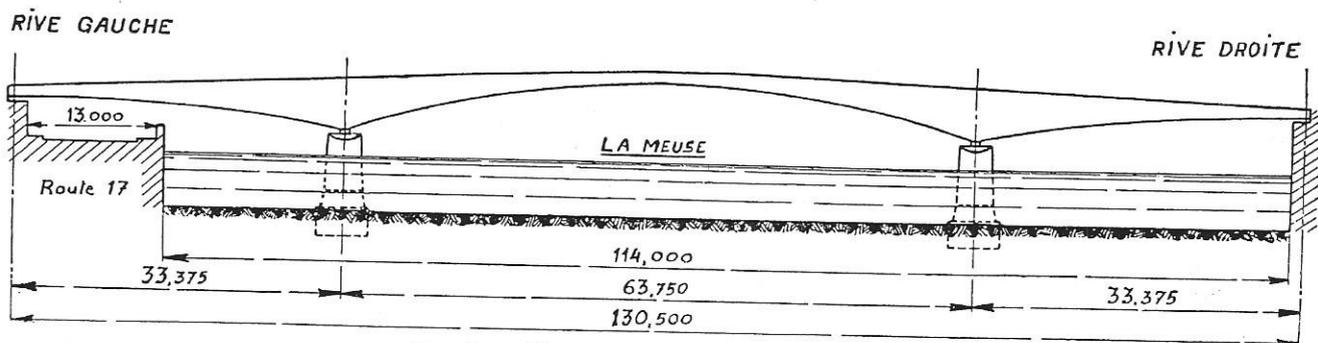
COUPE LONGITUDINALE DE L'OUVRAGE.
